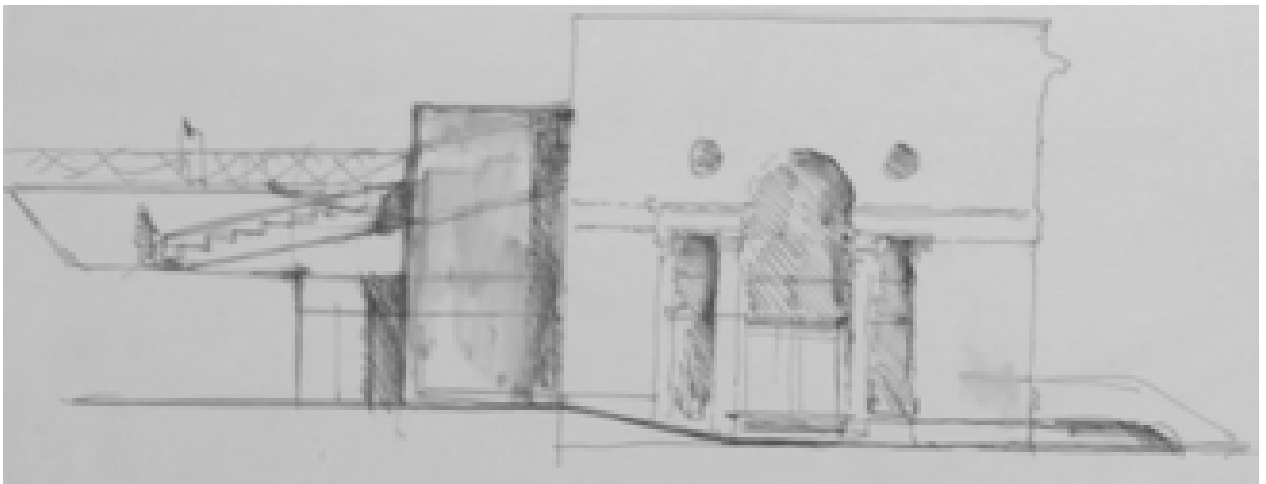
Prospetto di studio della Limonaia (AABS-952)
